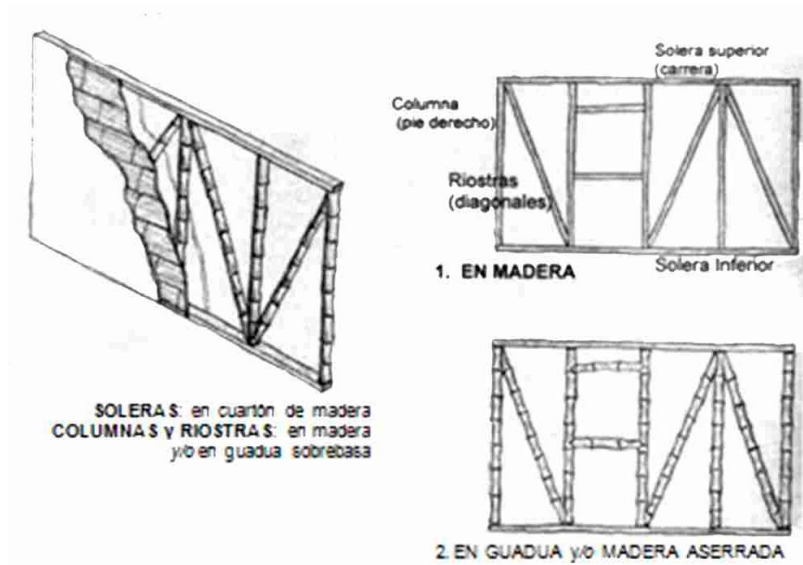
Estructura entramado muro bahareque. Fuente: [Montoya](#). 1987
